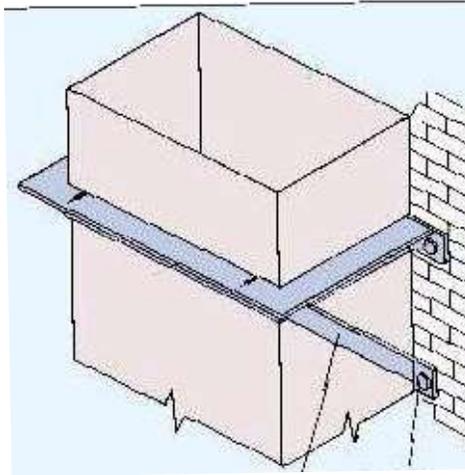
Ducto rectangular horizontal con soporte de tirante, [3].
